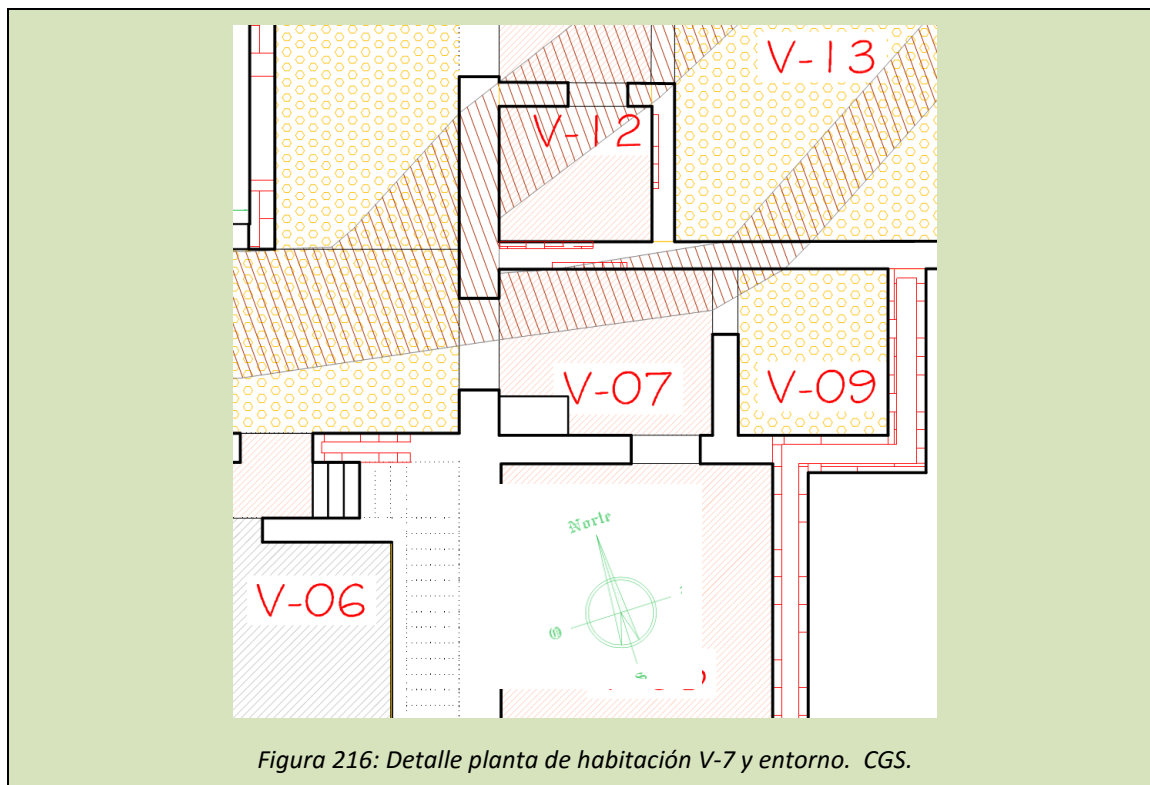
Detalle planta de habitación V-7 y entorno. CGS.
